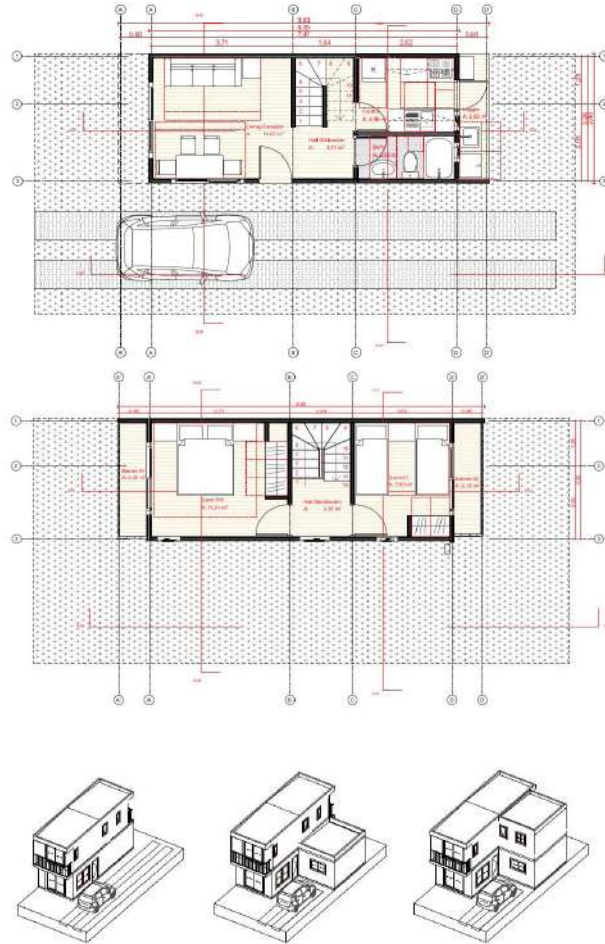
Planimetría proyecto Viviendas Sociales, oficina Biourban.
